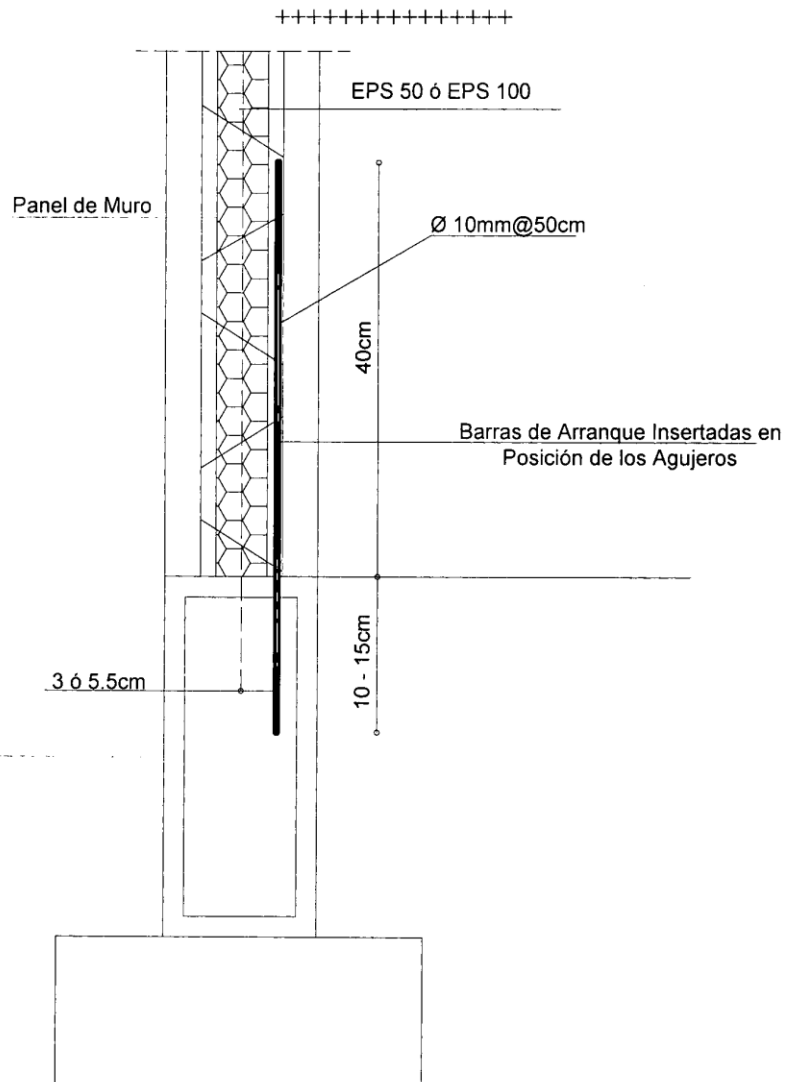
Conexión entre la losa de cimentación y el muro exterior mediante las barras de arranque (cimentación corrida).
